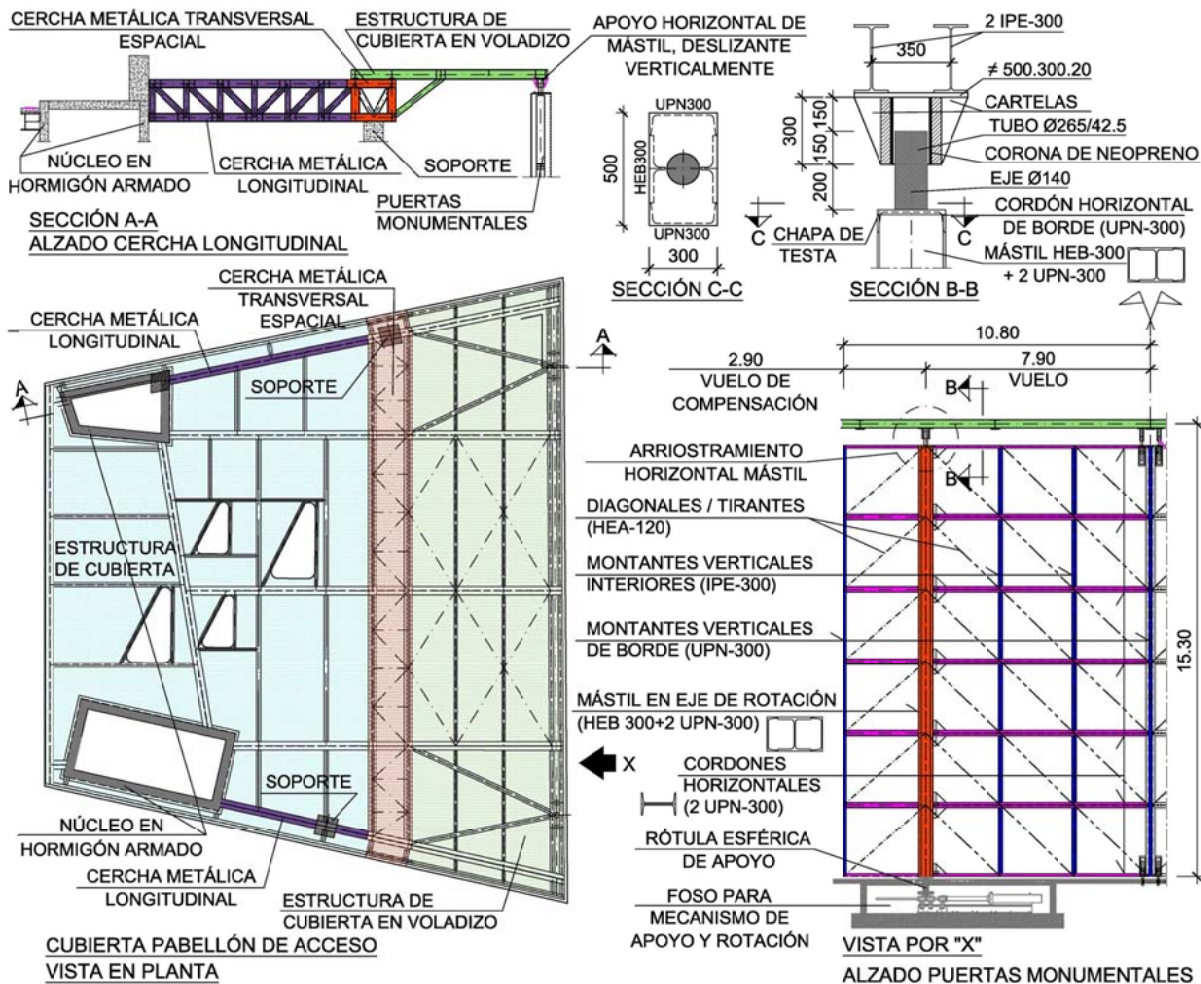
Pabellón de acceso – estructura de cubierta y puertas monumentales
